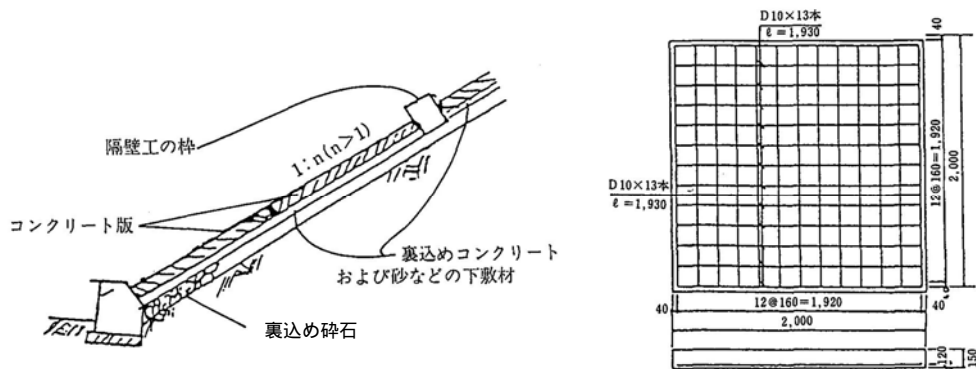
コンクリート版張工の施工断面例とコンクリート版の一例
